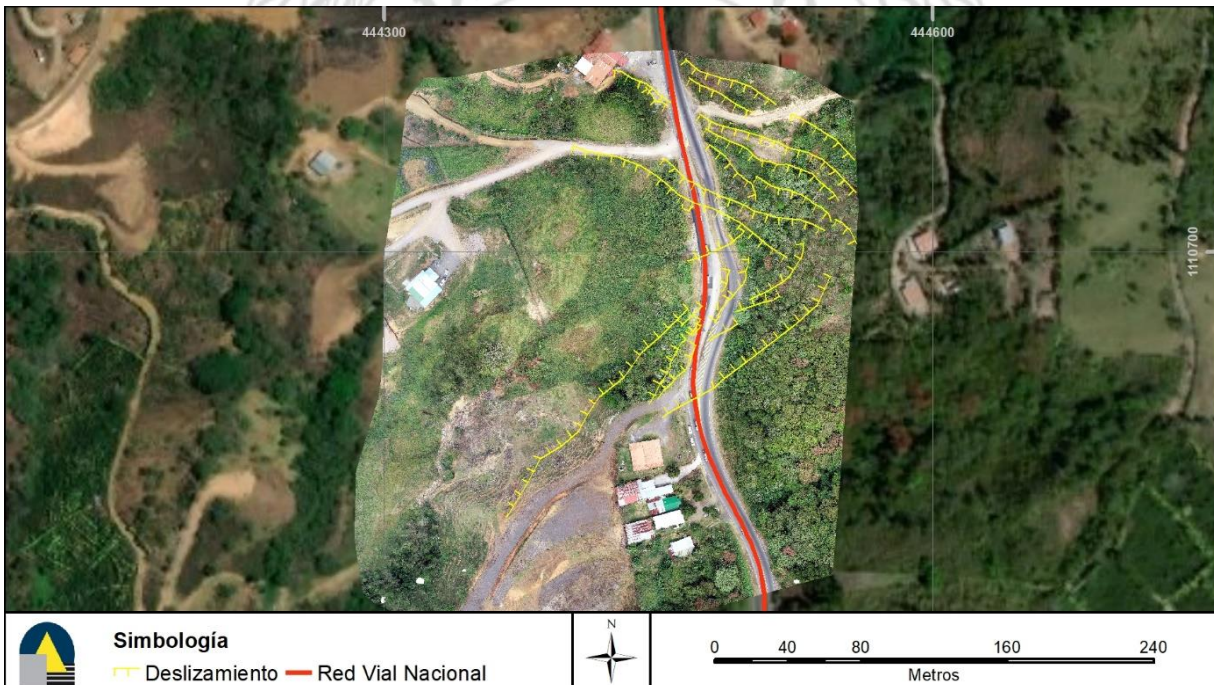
Ortografía del sitio P2. Las líneas amarillas marcan la ubicación de las grietas observadas en el campo, así como en el modelo de elevación digital levantado con el VANT.
